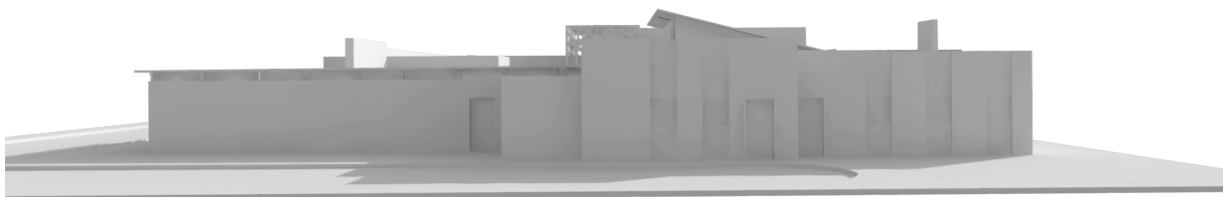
Vista de servicios. Fachada posterior poniente.
